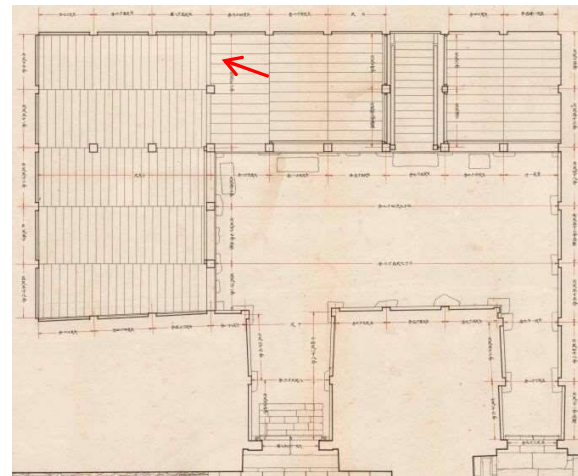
昭和実測図「小天守地階平面図」(部分)
